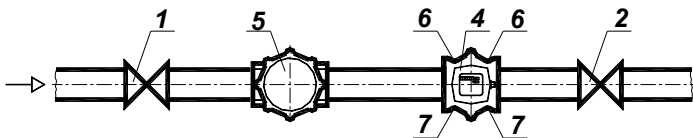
Схема монтажа счетчика (безбайпасная) на горизонтальном газопроводе
